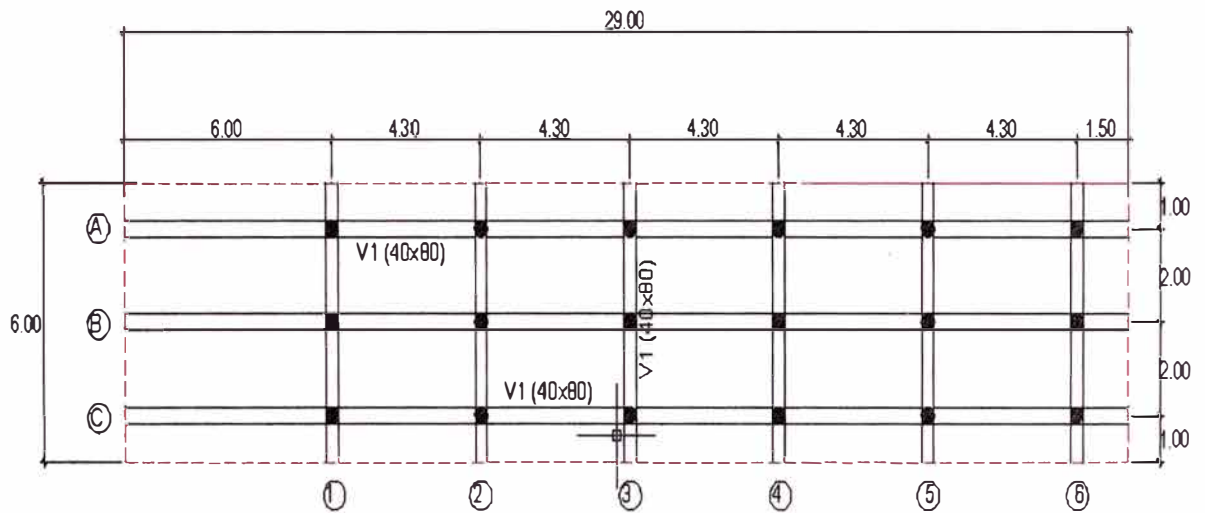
Distribución de vigas superiores en el 1er tramo
